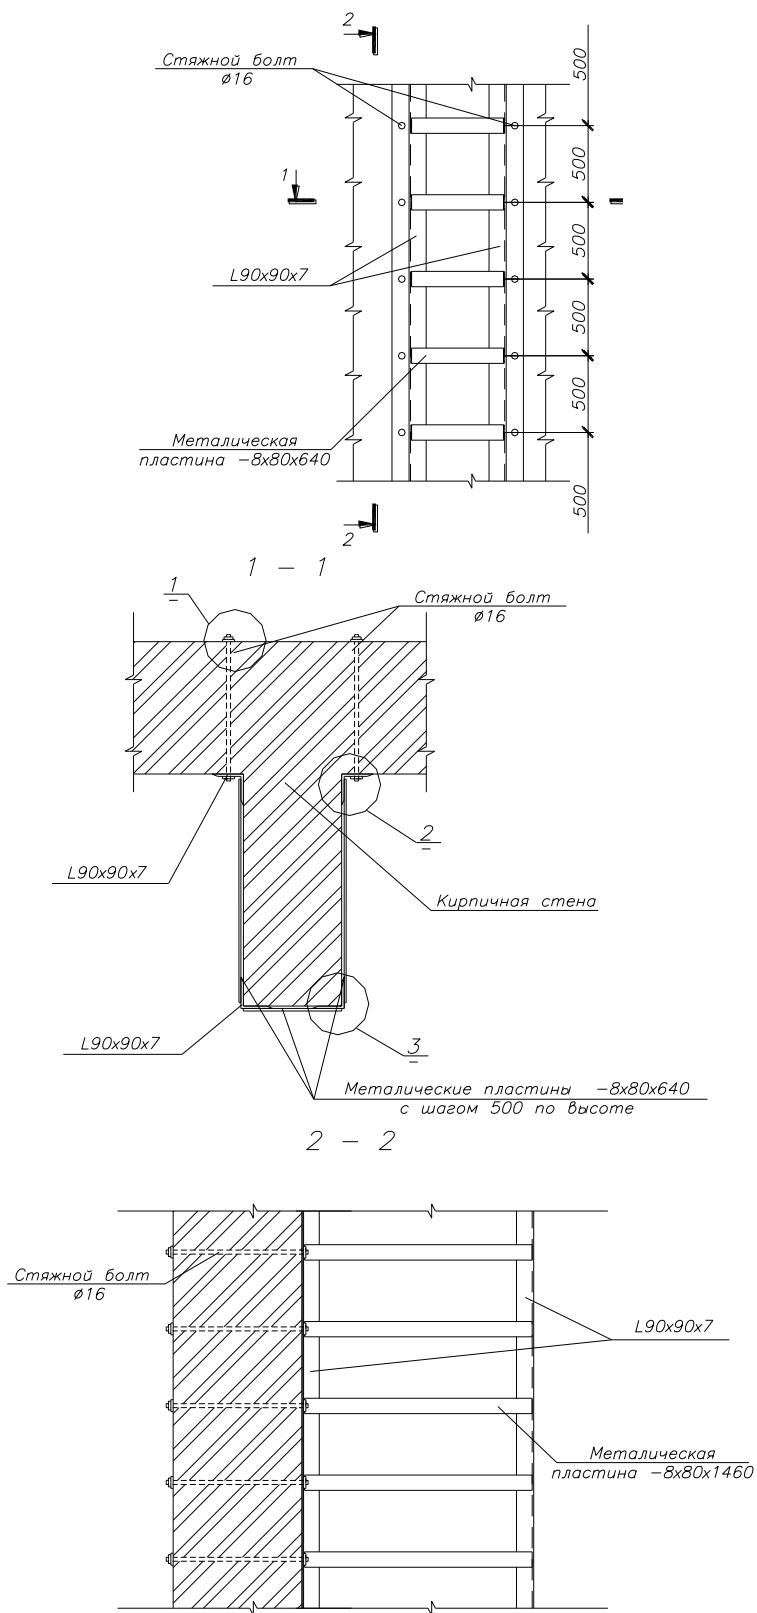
Схемы усиления облицовочного ряда кирпичной кладки пиллястр
